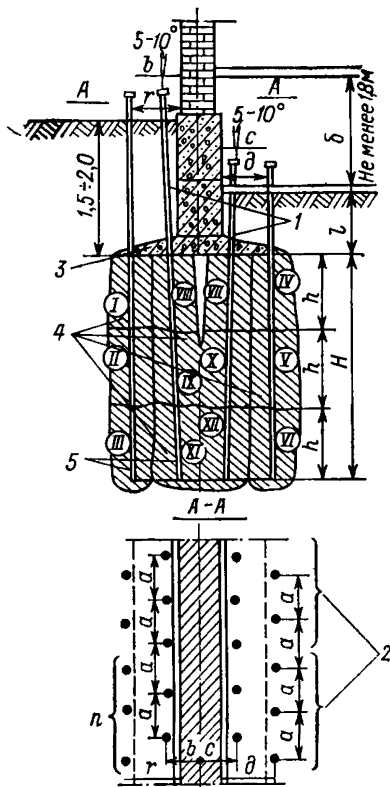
Размещение инъекторов при закреплении грунта под широкими сборными фундаментами
